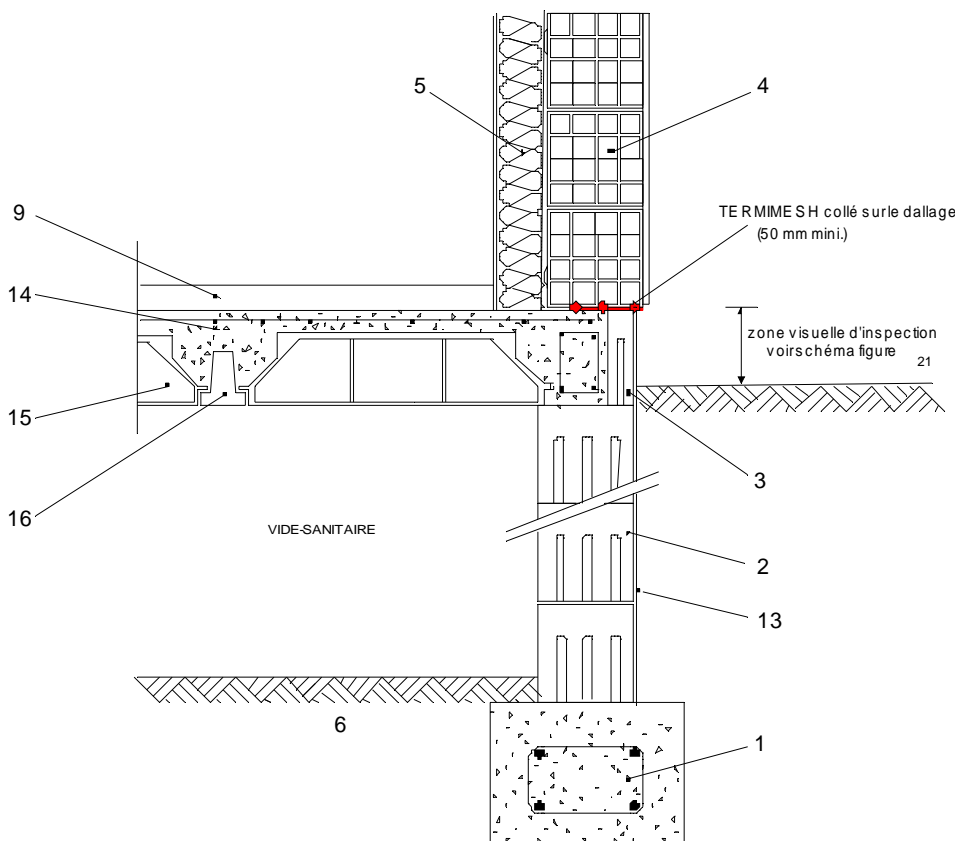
EU 2.1-1 : Plancher béton avec planelle brique ou béton, soubassement en blocs maçonnés (Vide sanitaire non contrôlable)
